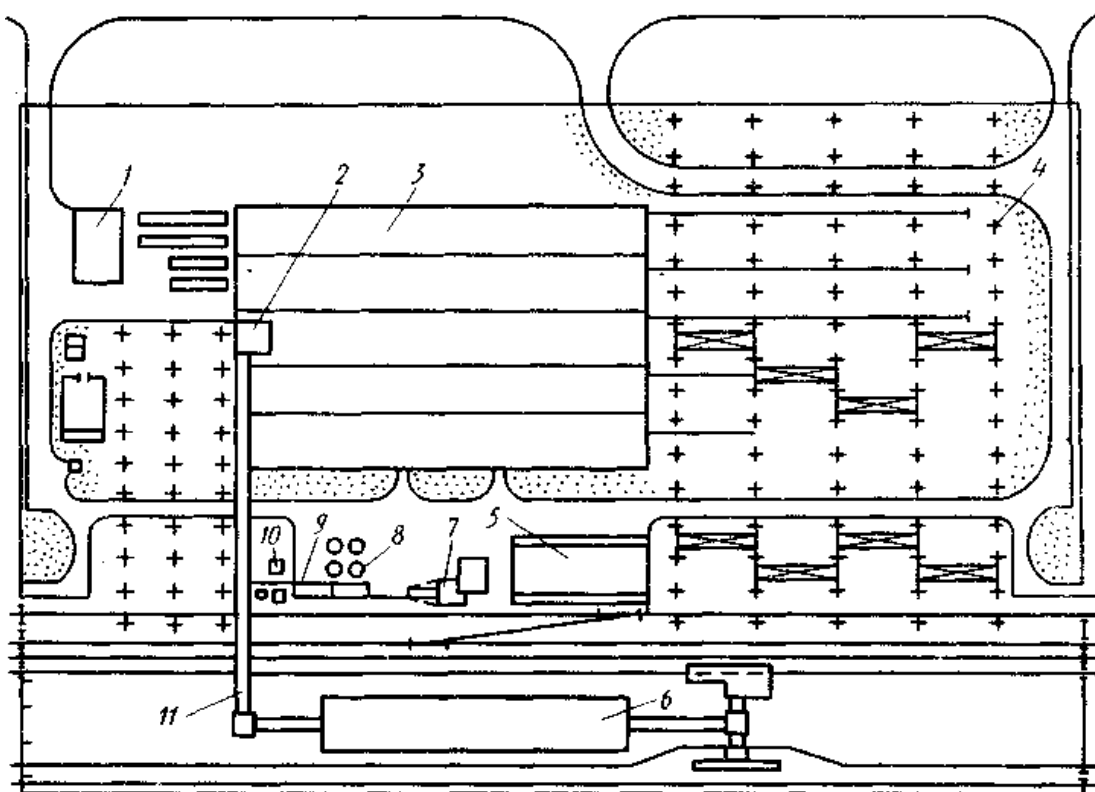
Генплан завода по производству железобетонных труб про-
